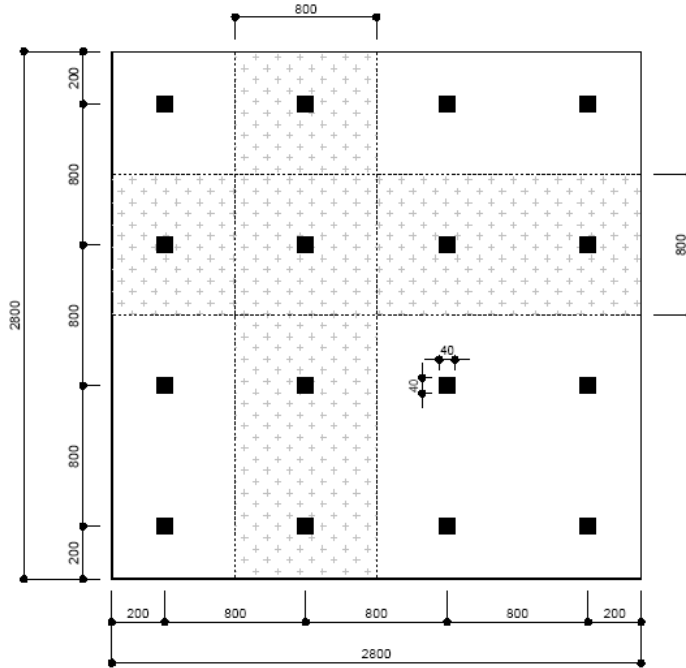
Geometria do pavimento (Pedrozo, 2009).
